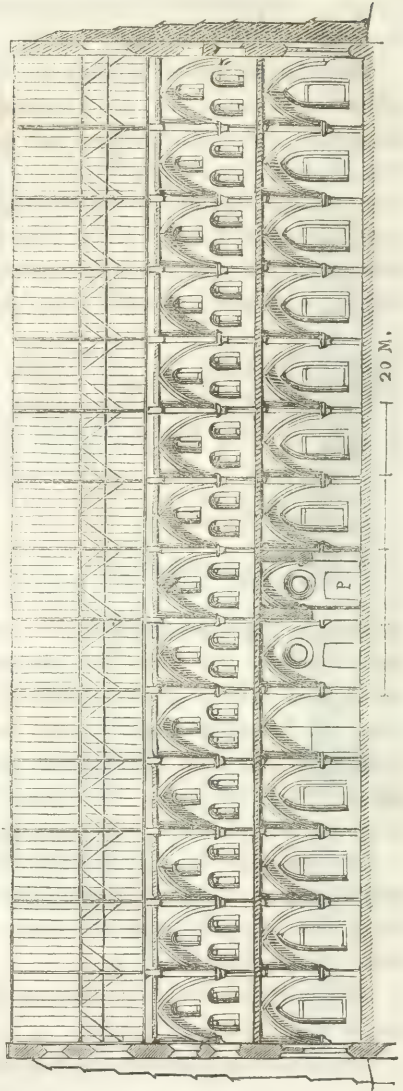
COUPE GÉNÉRALE DU BÂTIMENT.
